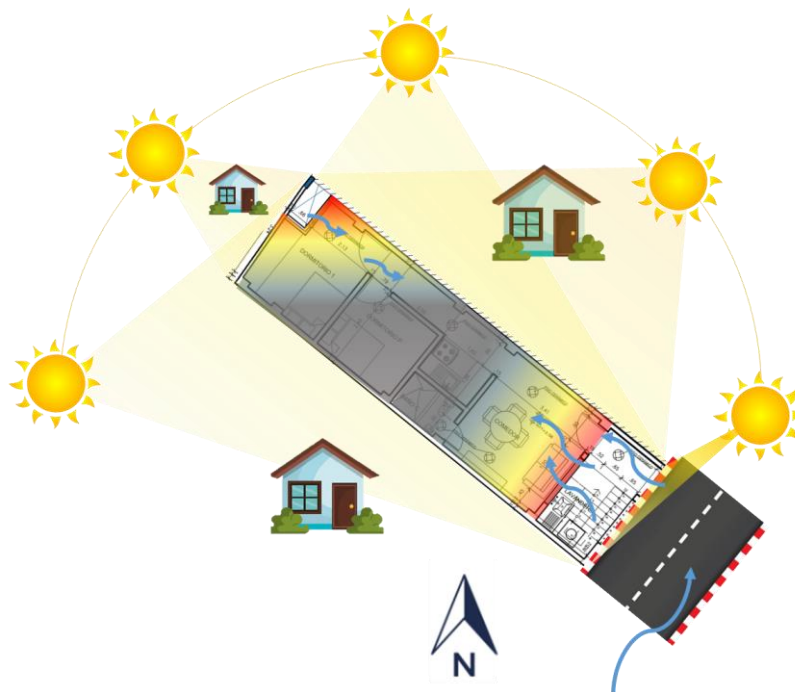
Plano de la vivienda LA – Nivel 1er piso
